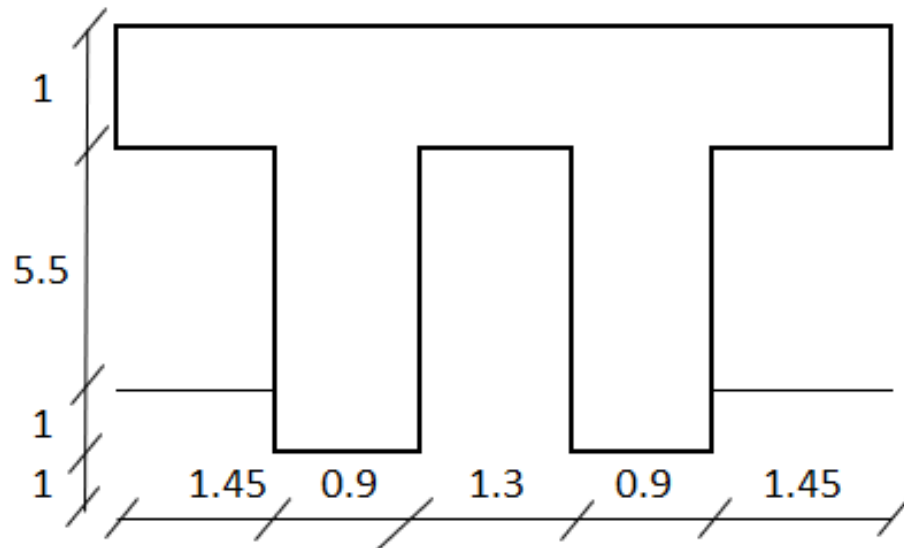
Centro de gravedad-FUENTE: ELABORACION PROPIA
